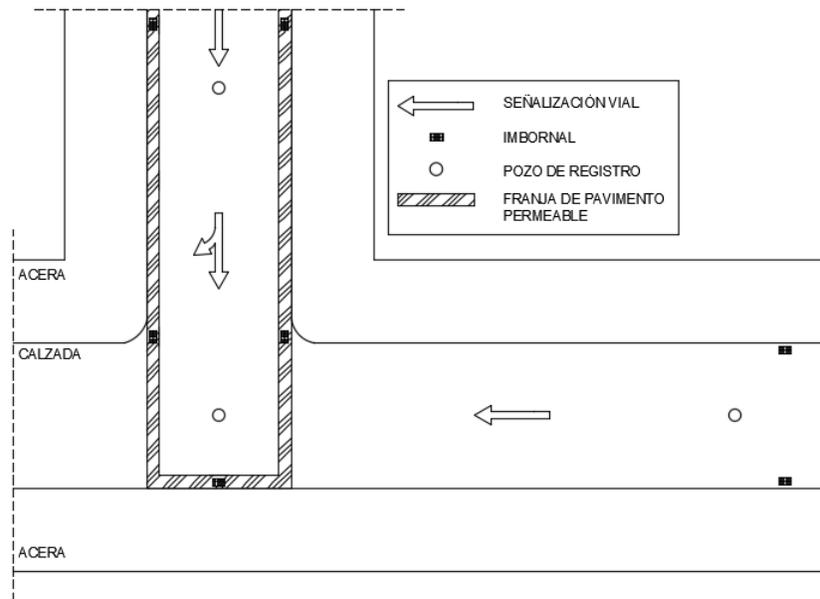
Planta de la red modificada con pozos y tubos drenantes
